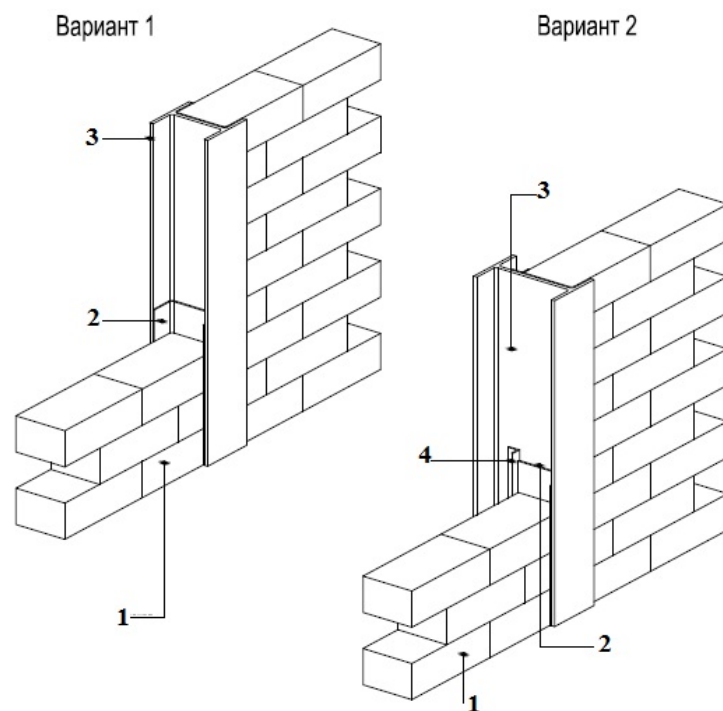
Соединение стены, заполняющей каркас, с металлической колонной: 1 — стена из блоков YTONG; 2 — пенополистирол, 10 мм; 3 — стальная колонна; 4 — металлический уголок
